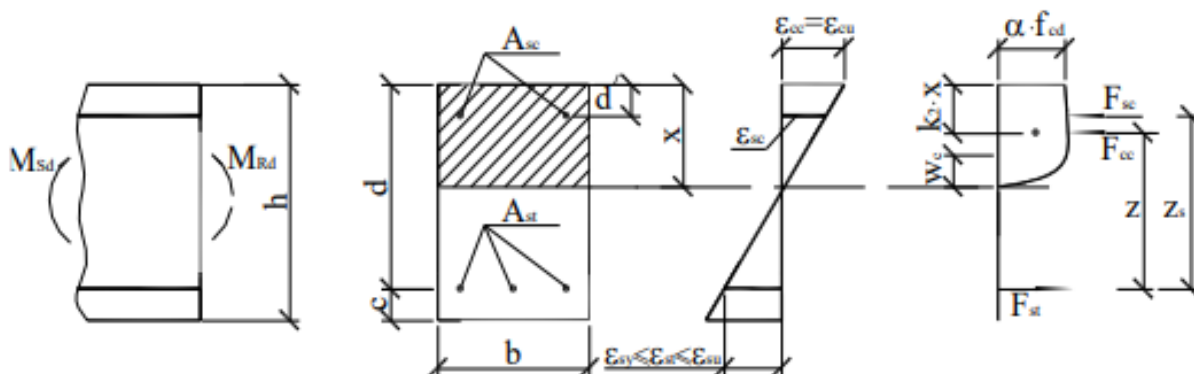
Схема распределения относительных усилий при определении предельного момента для прямоугольных сечений с двойным армированием.
